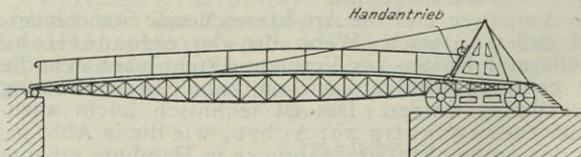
Rollbrücke mit Stufen zum Höhenausgleich.
